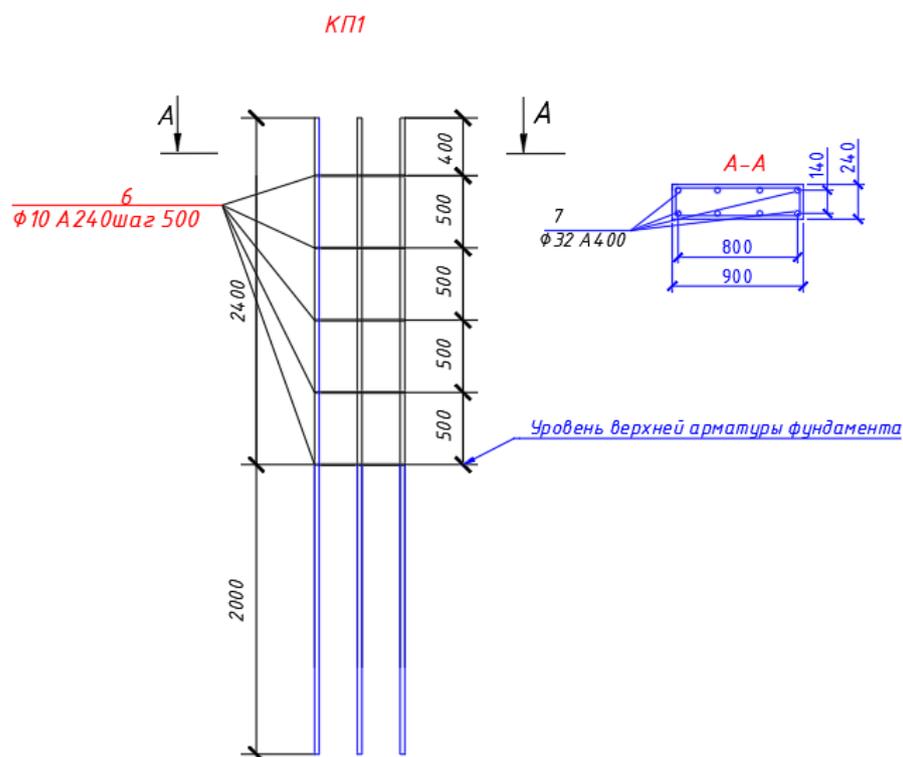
Соединение монолитной железобетонной колонны с монолитным фундаментом
